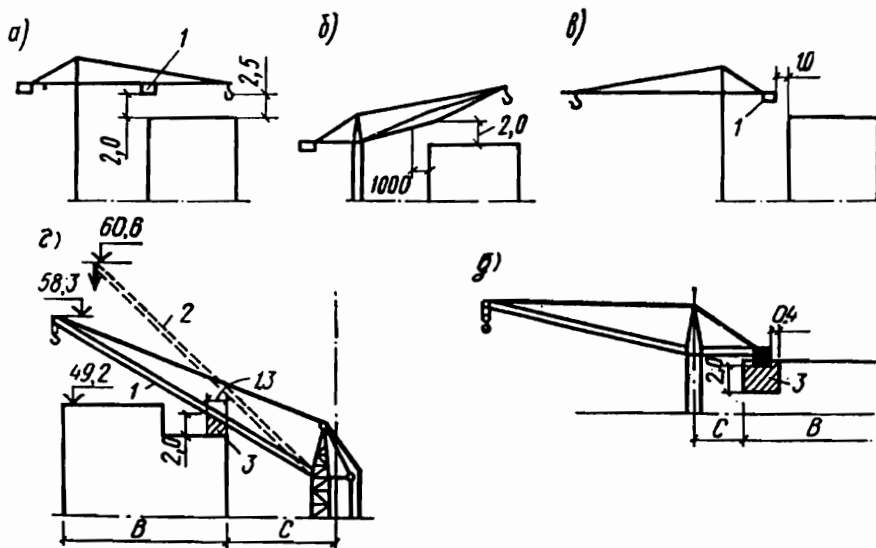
Минимально допустимые расстояния от конструкций монтажных механизмов до строящегося здания (а, б, в): а – от крюка или противовеса до монтажного горизонта; б- от стрелы до здания; в - от противовеса крана до здания; 1 – противовес над монтажным горизонтом при повороте крана; г, д – опасные зоны при монтаже здания: г – при наибольшем вылете крюка башенного крана; д – при перемещении противовеса на уровне монтажного горизонта; 1- положение стрелы при наибольшем вылете; 2 – положение стрелы при наименьшем вылете; 3 – опасная зона
